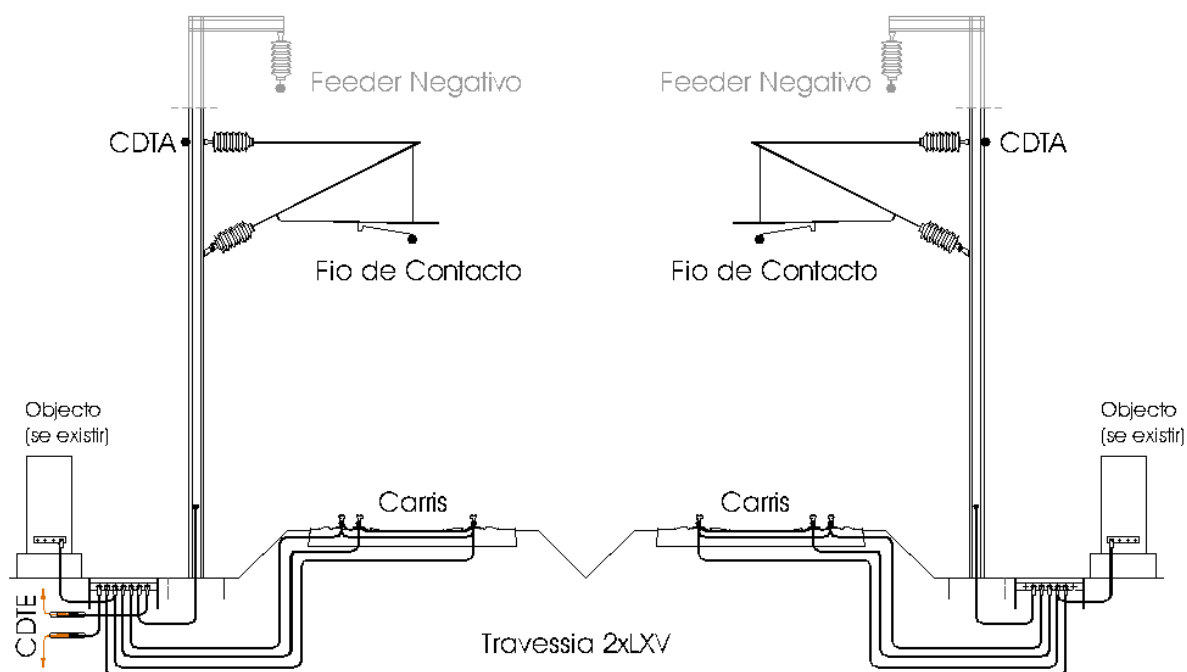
LTI para via dupla a 3 carris com um CDTE; desenho de princípio; Sistema AT
